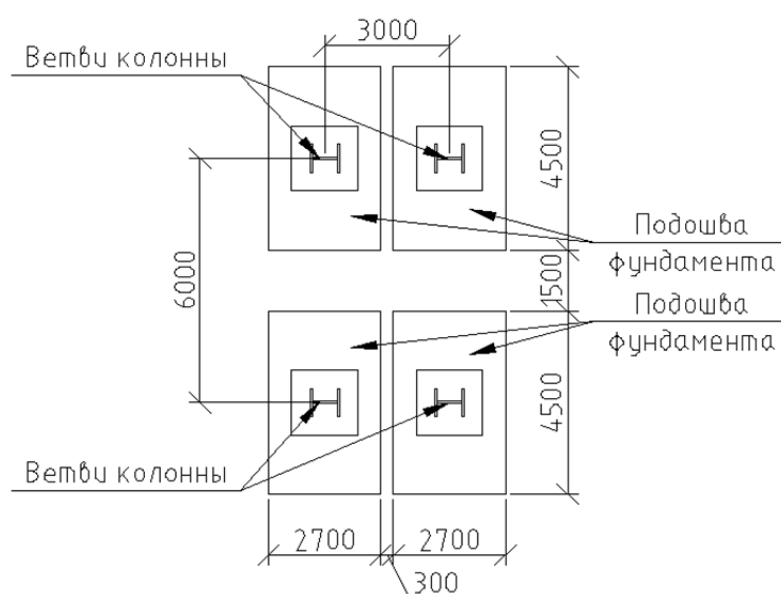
Схема конструирования столбчатого фундамента под ветви колонн
